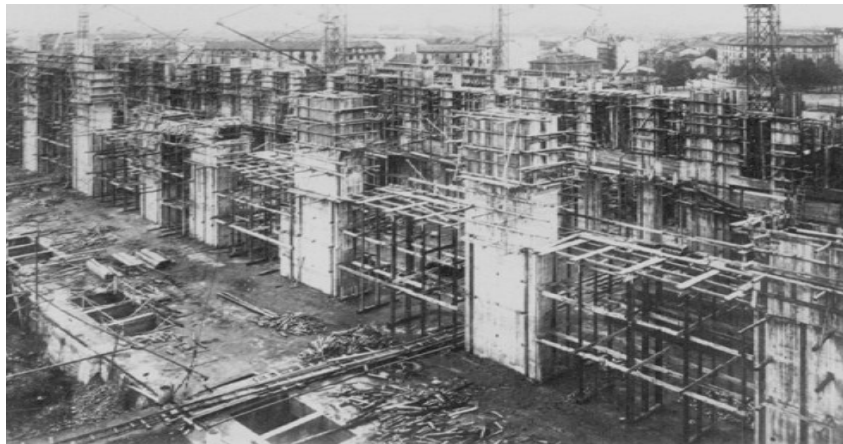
Costruzione della struttura in calcestruzzo armato nel 1929
